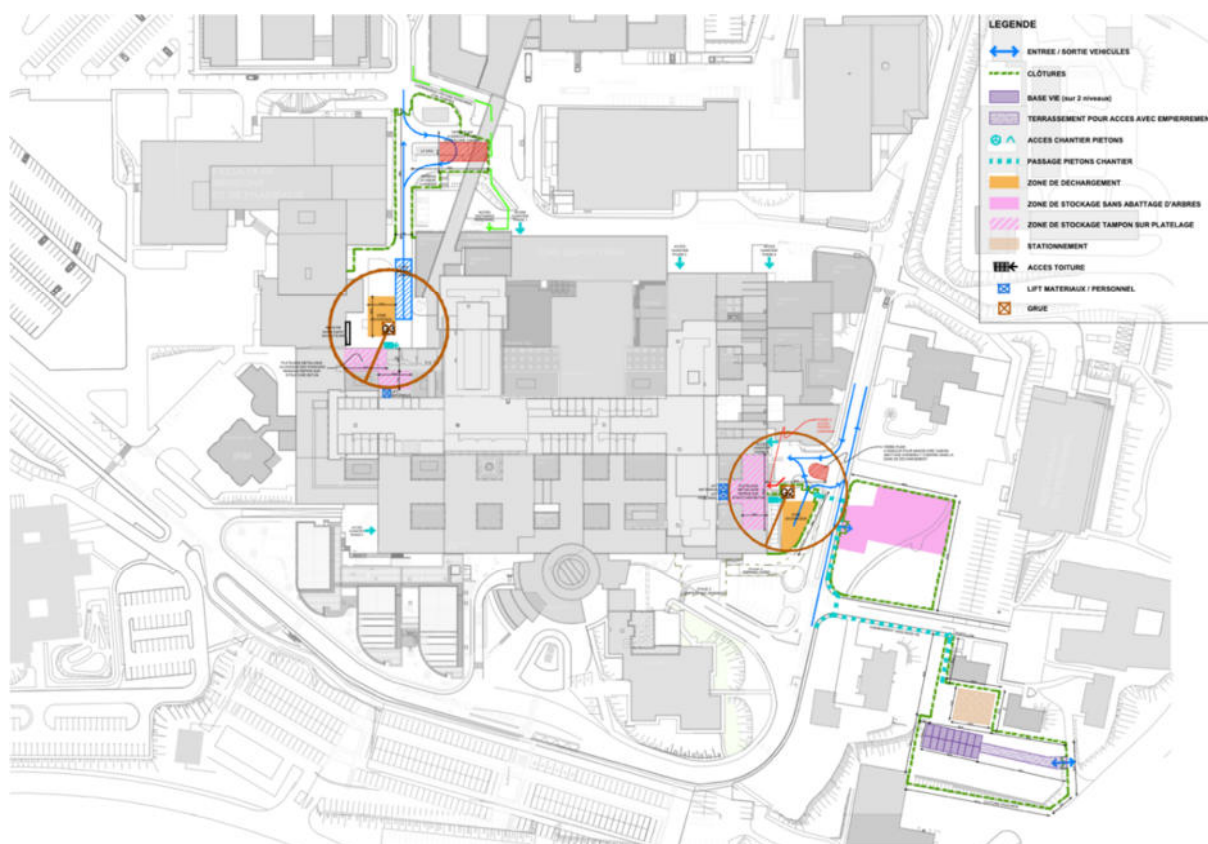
Implantation géographique de l'installation de chantier sur le site du CHU de Limoges – Bâtiment DUPUYTREN 1
